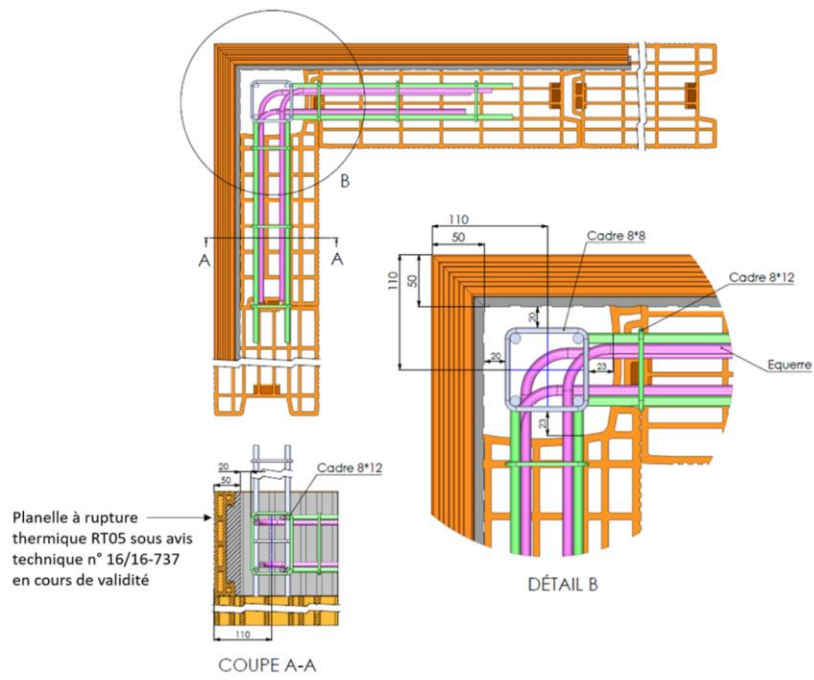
coupes horizontales et verticales sur planelles à rupture thermique
